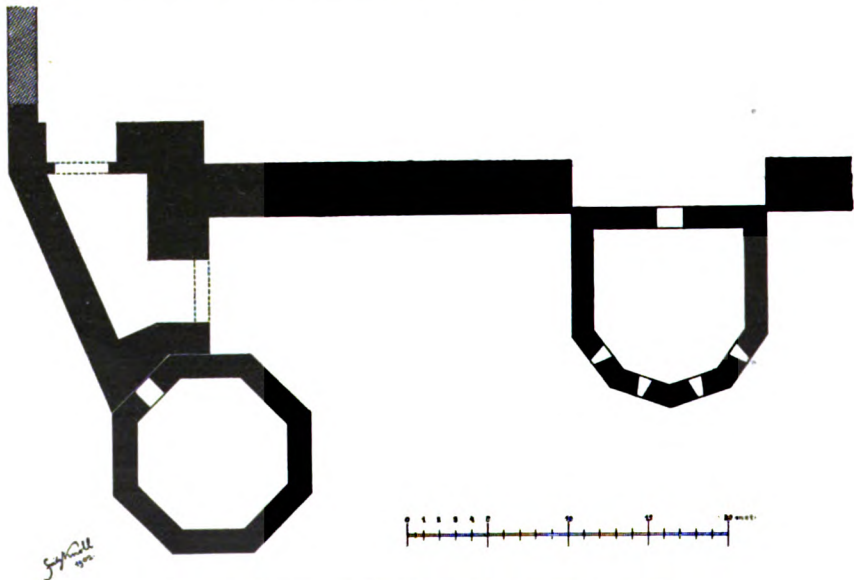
Grundriss des Südtors von Isaura.
